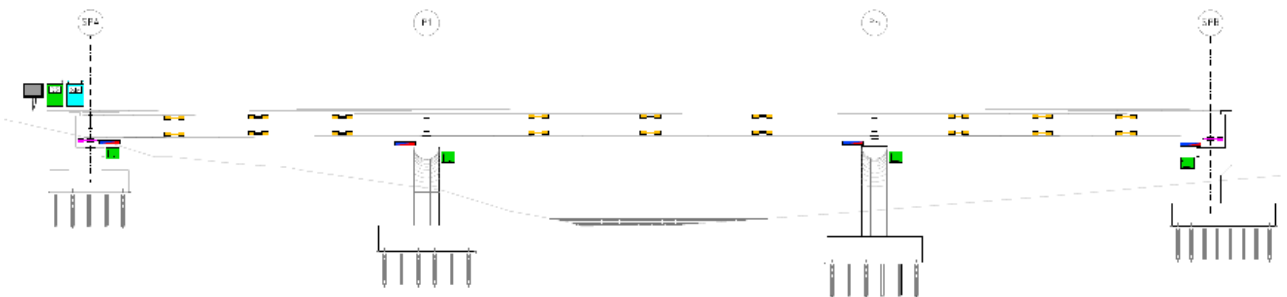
Schema profilo impalcato posizionamento strumentazione viadotti
